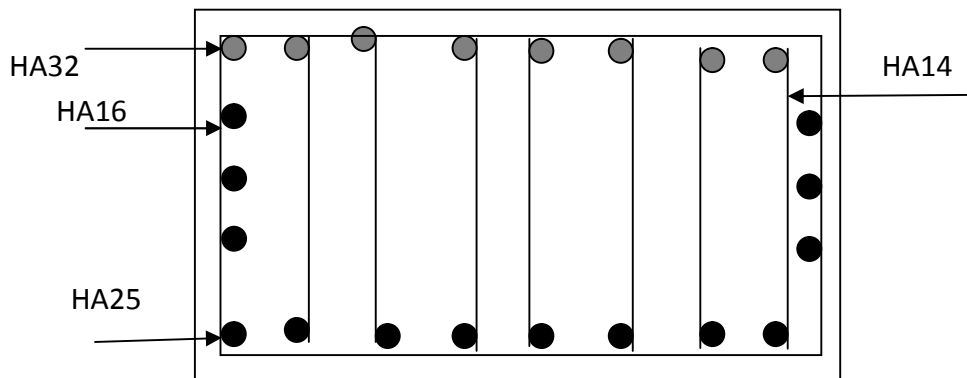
Ferrailage du chevêtre de la pile
